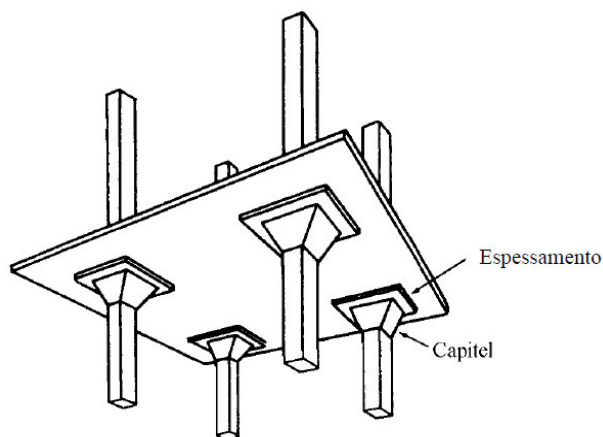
Laje Fungiforme Maciça com Espessamento da Laje e Capitel [16]
